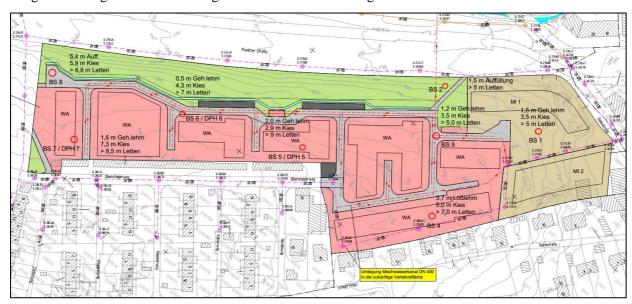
Baugrundschichtung an den einzelnen Aufschlusspunkten in Bezug zur geplanten Bebauung
